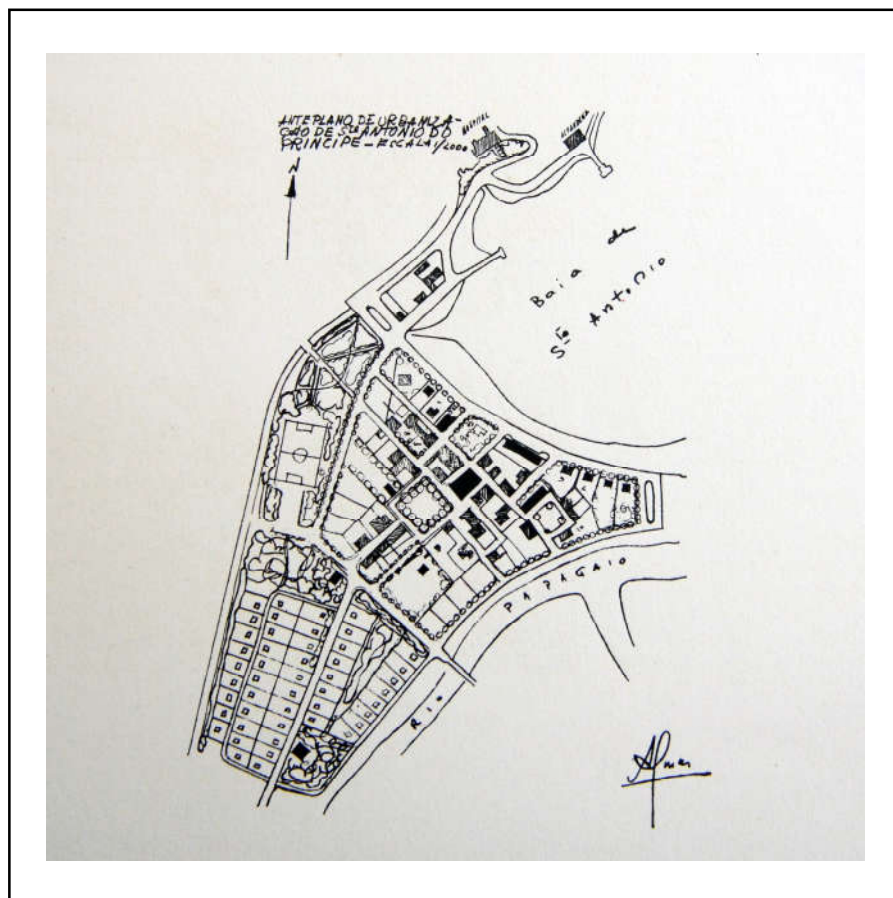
| Planta da Baía de Santo António do Príncipe |
